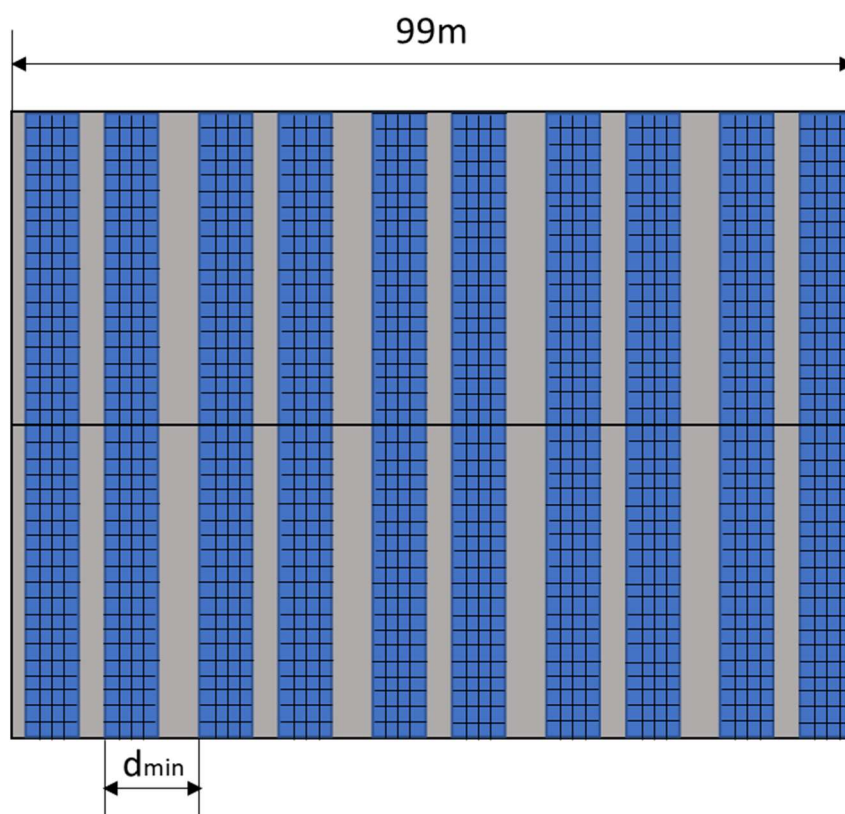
Boceto en planta de la instalación indicando la distancia mínima entre las columnas de paneles.
